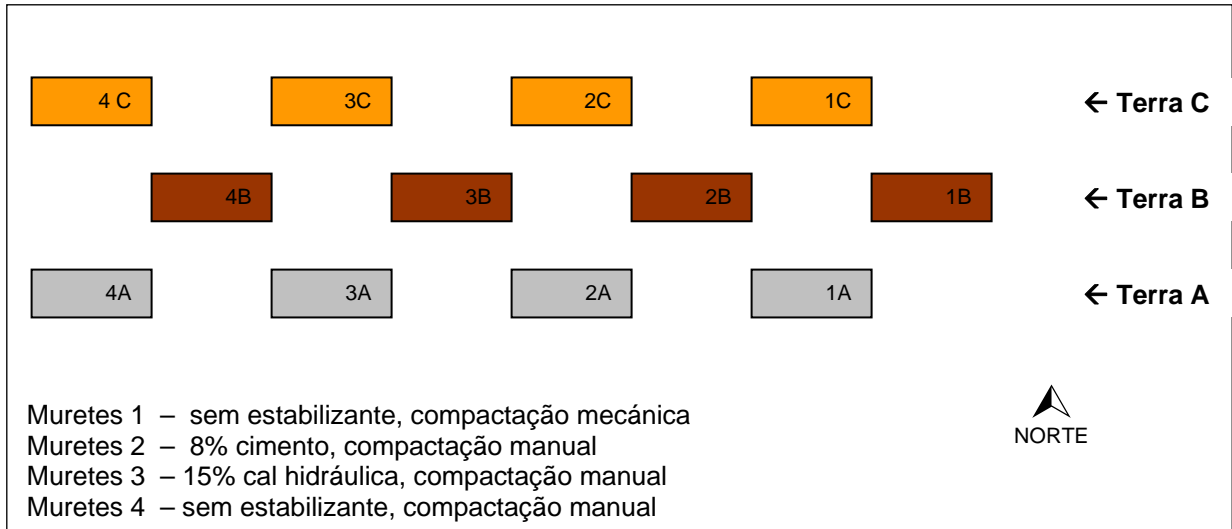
Configuração, implantação e orientação do parque de muretes da Horta do Chó.
